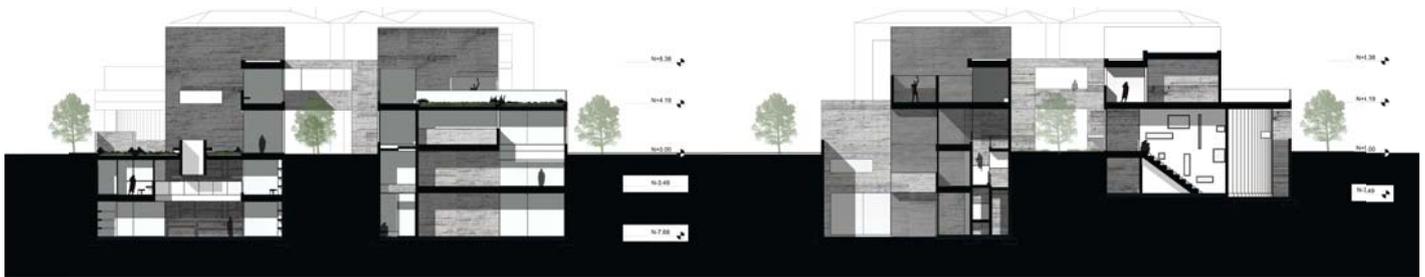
Fachada Norte. Fuente: Elaborado por el autor
